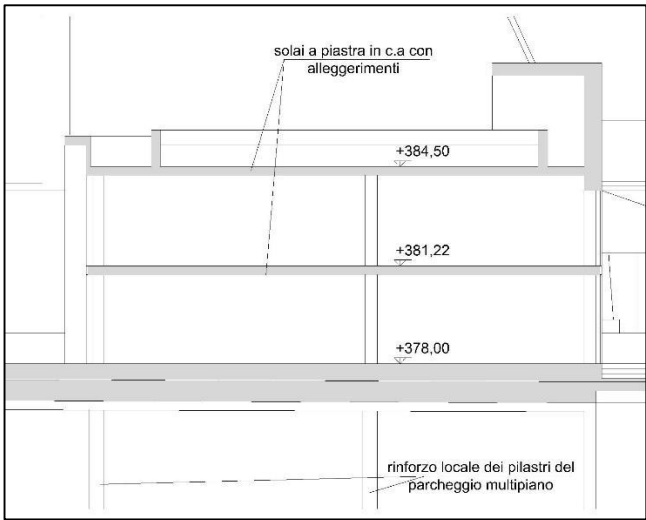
Sezione edificio per esposizione con prime indicazioni strutturali
